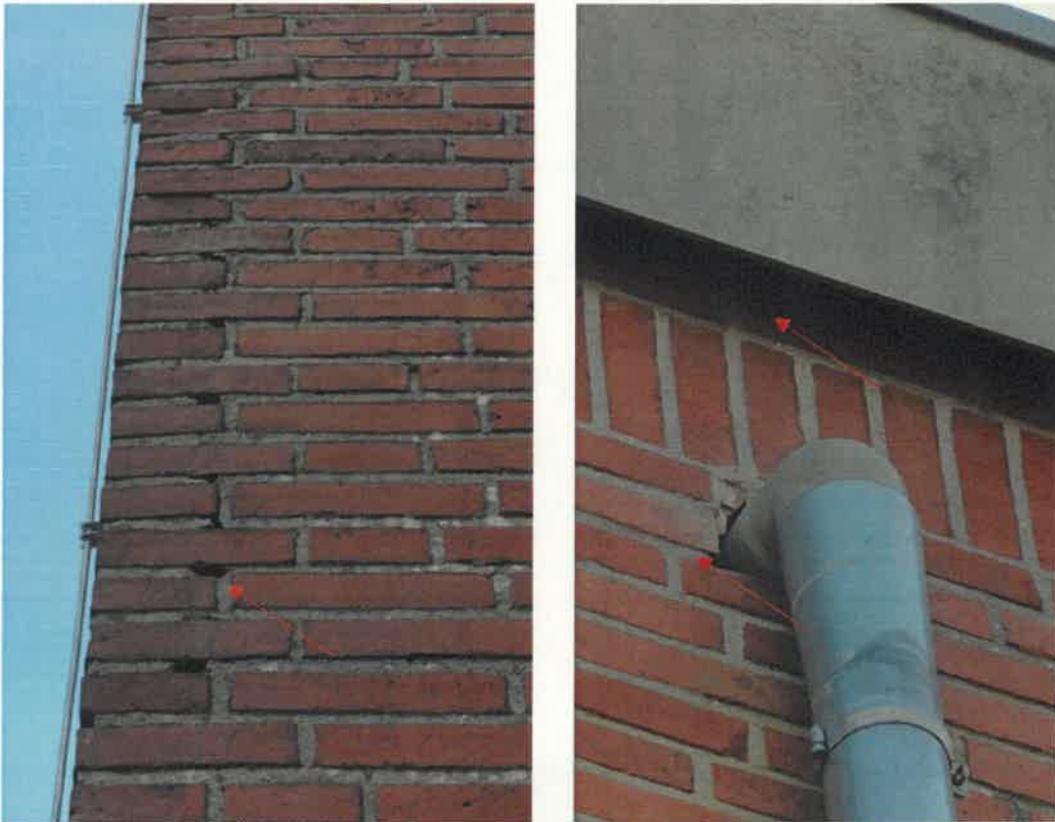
Risse, Öffnungen im Mauerwerk und Spalten hinter Blechverkleidung als Einflugmöglichkeiten am Gebäude Nr. 6
